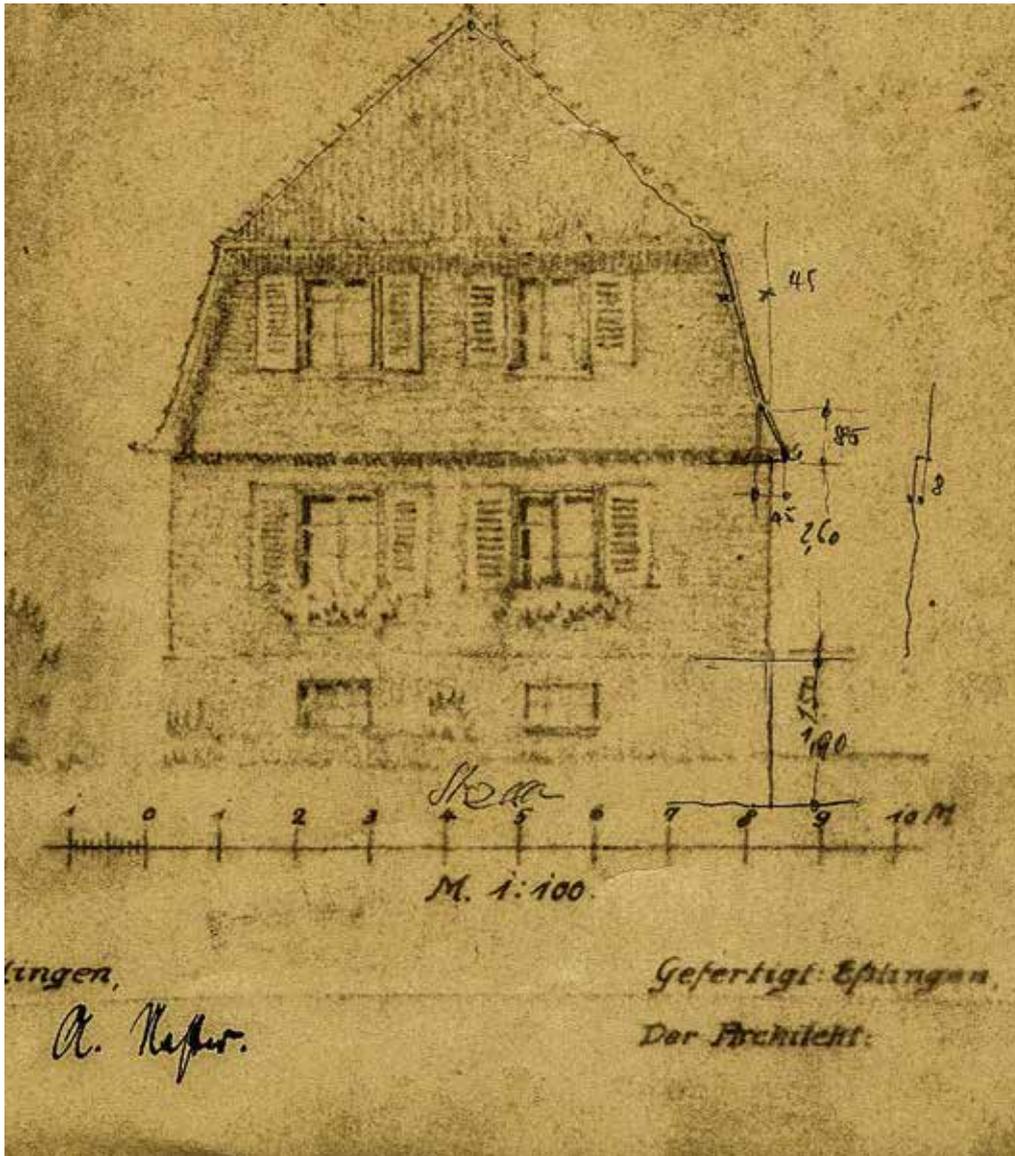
Grundriss Rüderner Straße 28 aus Bauantrag 1921, (Sammlung Welk)
